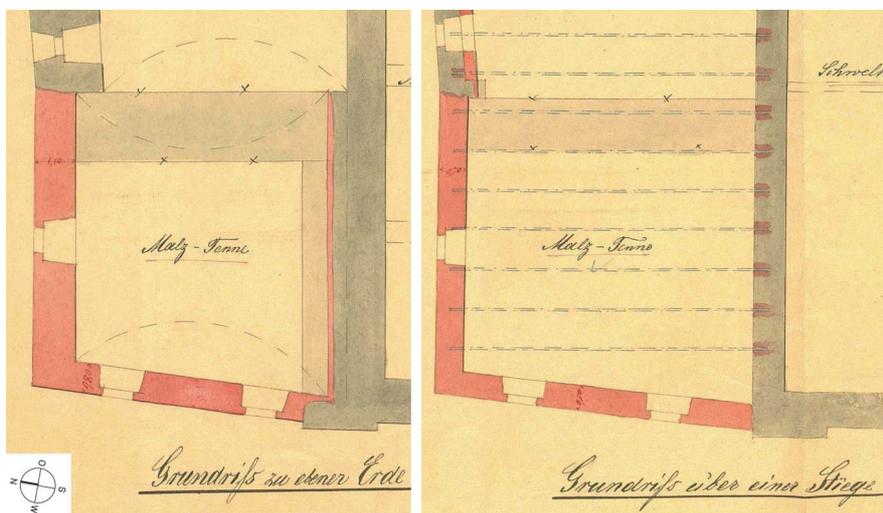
KG-Grundriss (links) und EG-Grundriss (rechts) für den Umbau und die Vergrößerung der Malz-Tenne aus dem StAAm/Bezirksamt Landratsamt Cham, Baugenehmigungsakte 134/1894 (Einbauten sind rot eingefärbt/abgetragenes Mauerwerk ist hellgrau eingefärbt)
